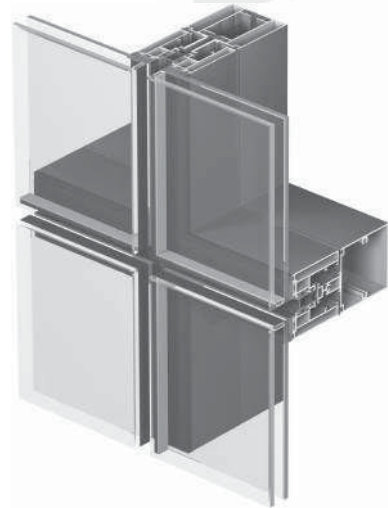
, sección en cruce de muro cortina, http://www.hye.com.mx/images/perf_alum/perfil_aluminio_preview.jpg
